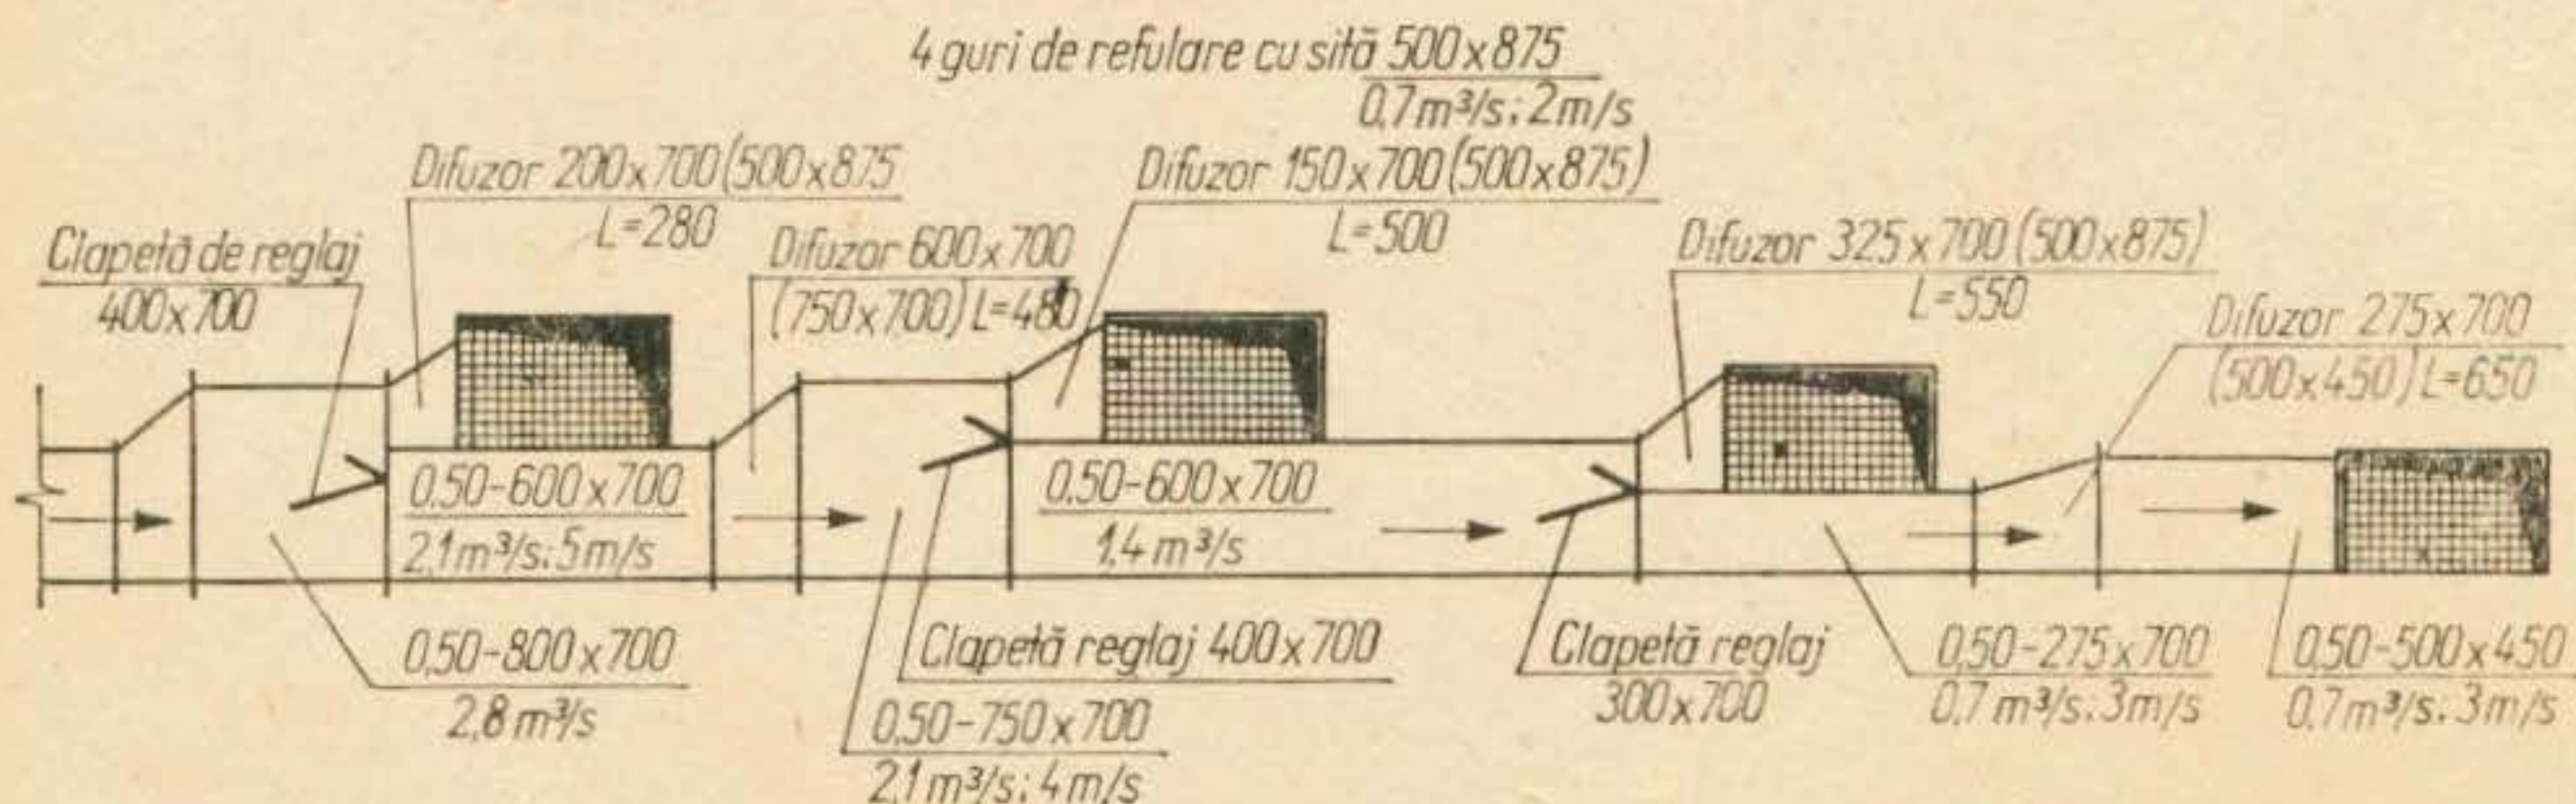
Canal cu patru guri de refulare, dispus în plan vertical.
